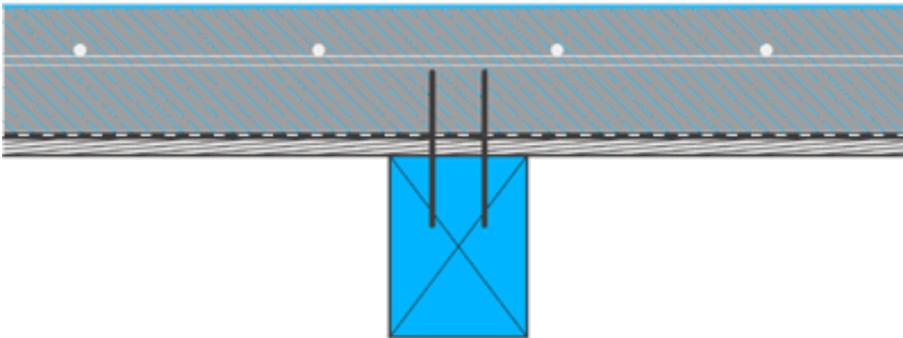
Holzbalken und Ortbeton¹²⁸
